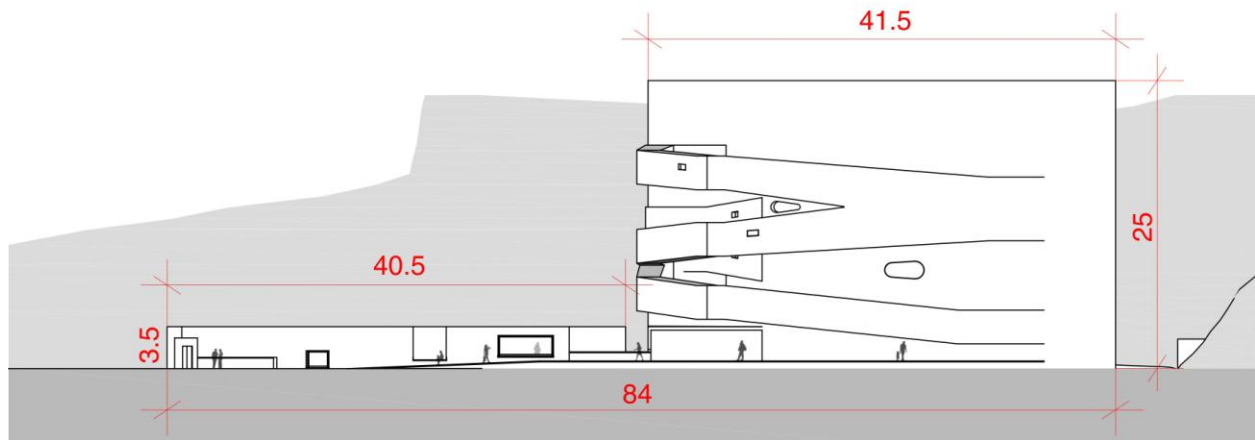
| Fachada Fundação Iberê Camargo, com dimensões | re-desenho da autora
